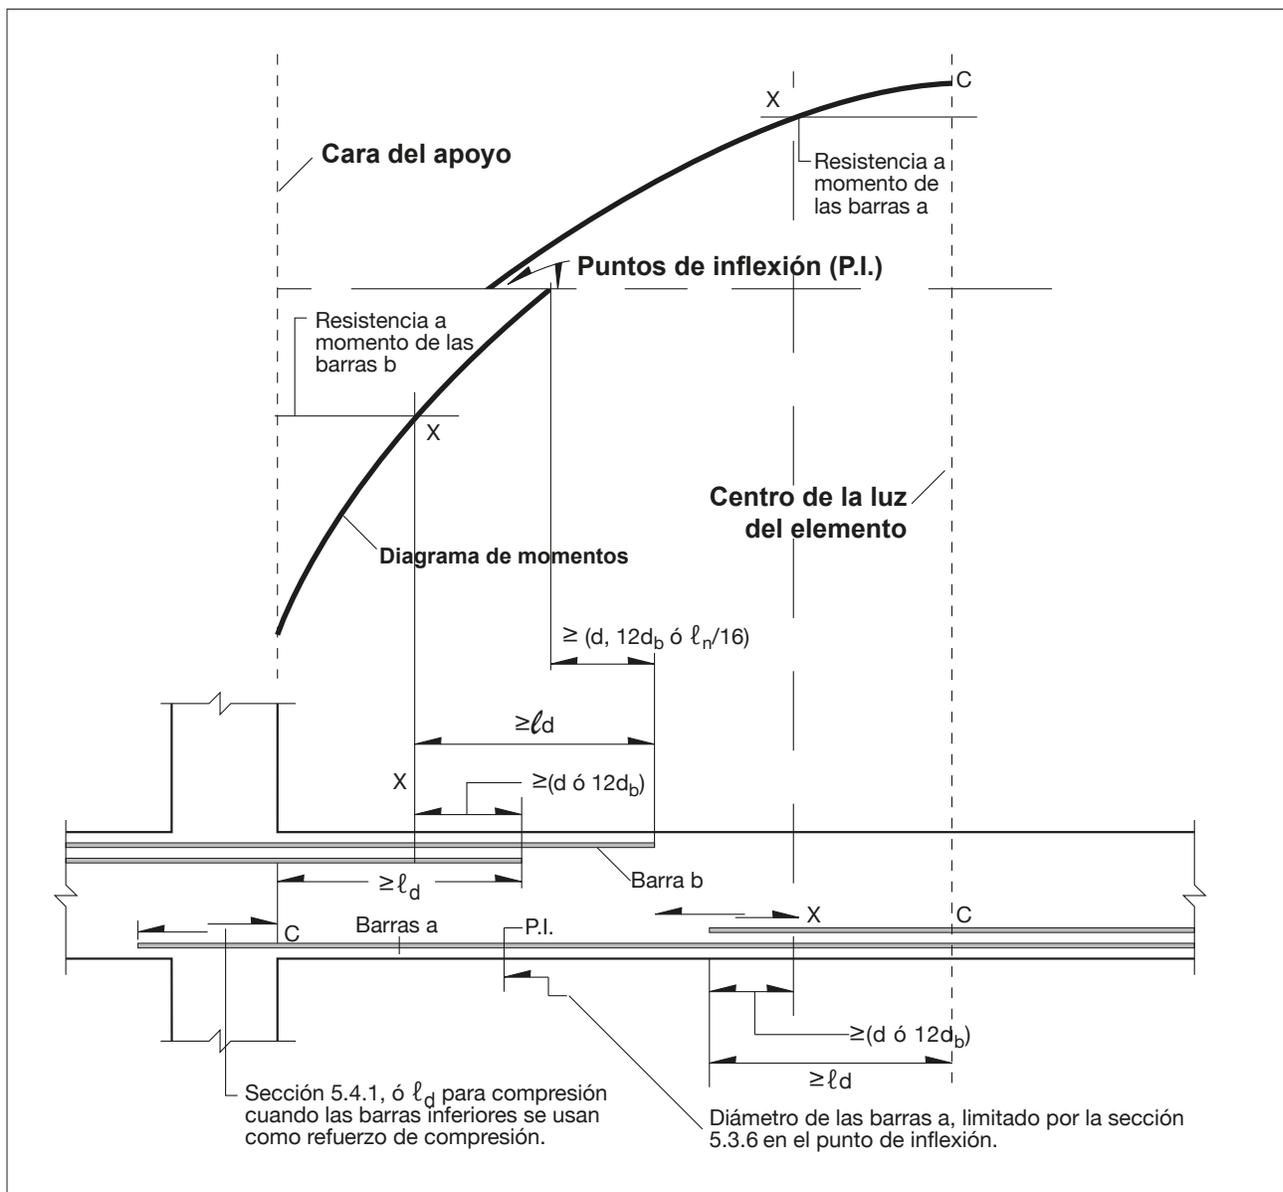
Ejemplo de Armadura por Flexión en una Viga Típica.
